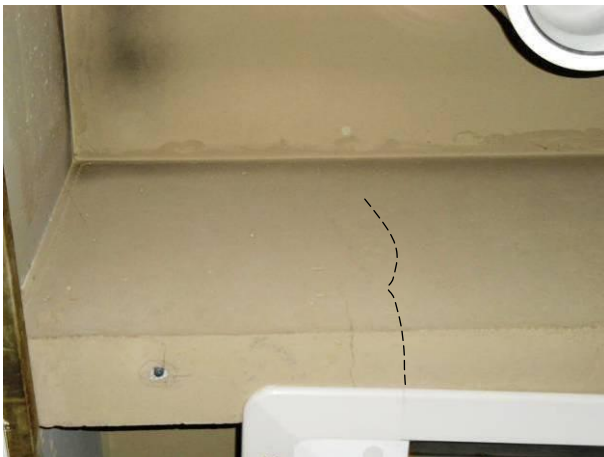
Fissura vertical com abertura de 0,3mm nas faces da Viga diagonal entre os pilares P15 e P16.
